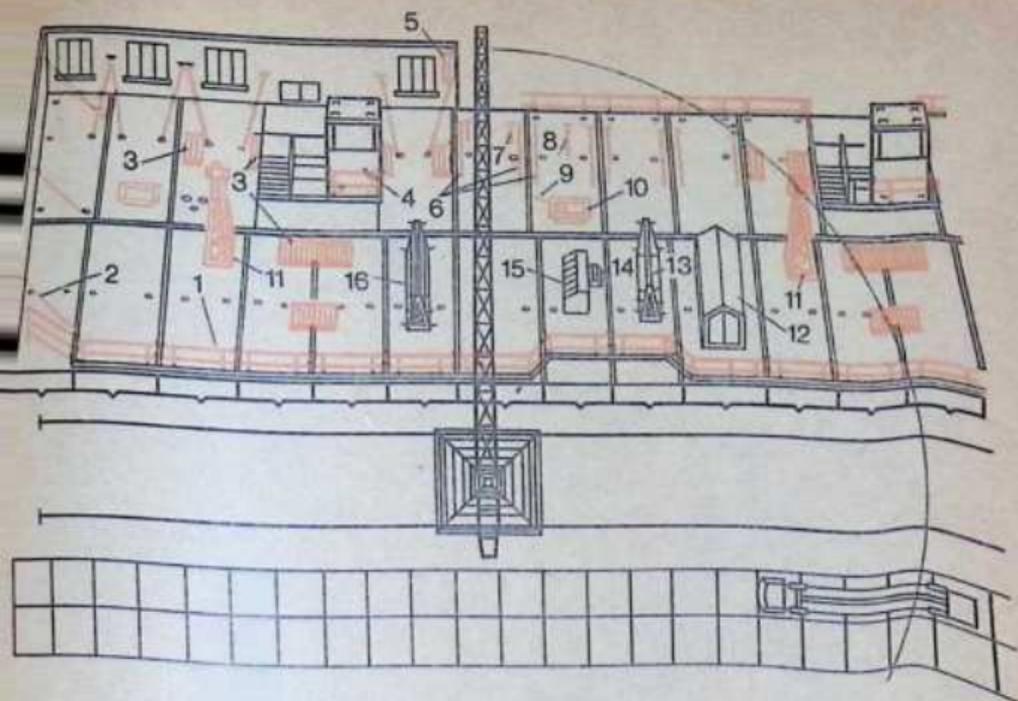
Организация рабочего места при монтаже стен крупнопанельного дома:
